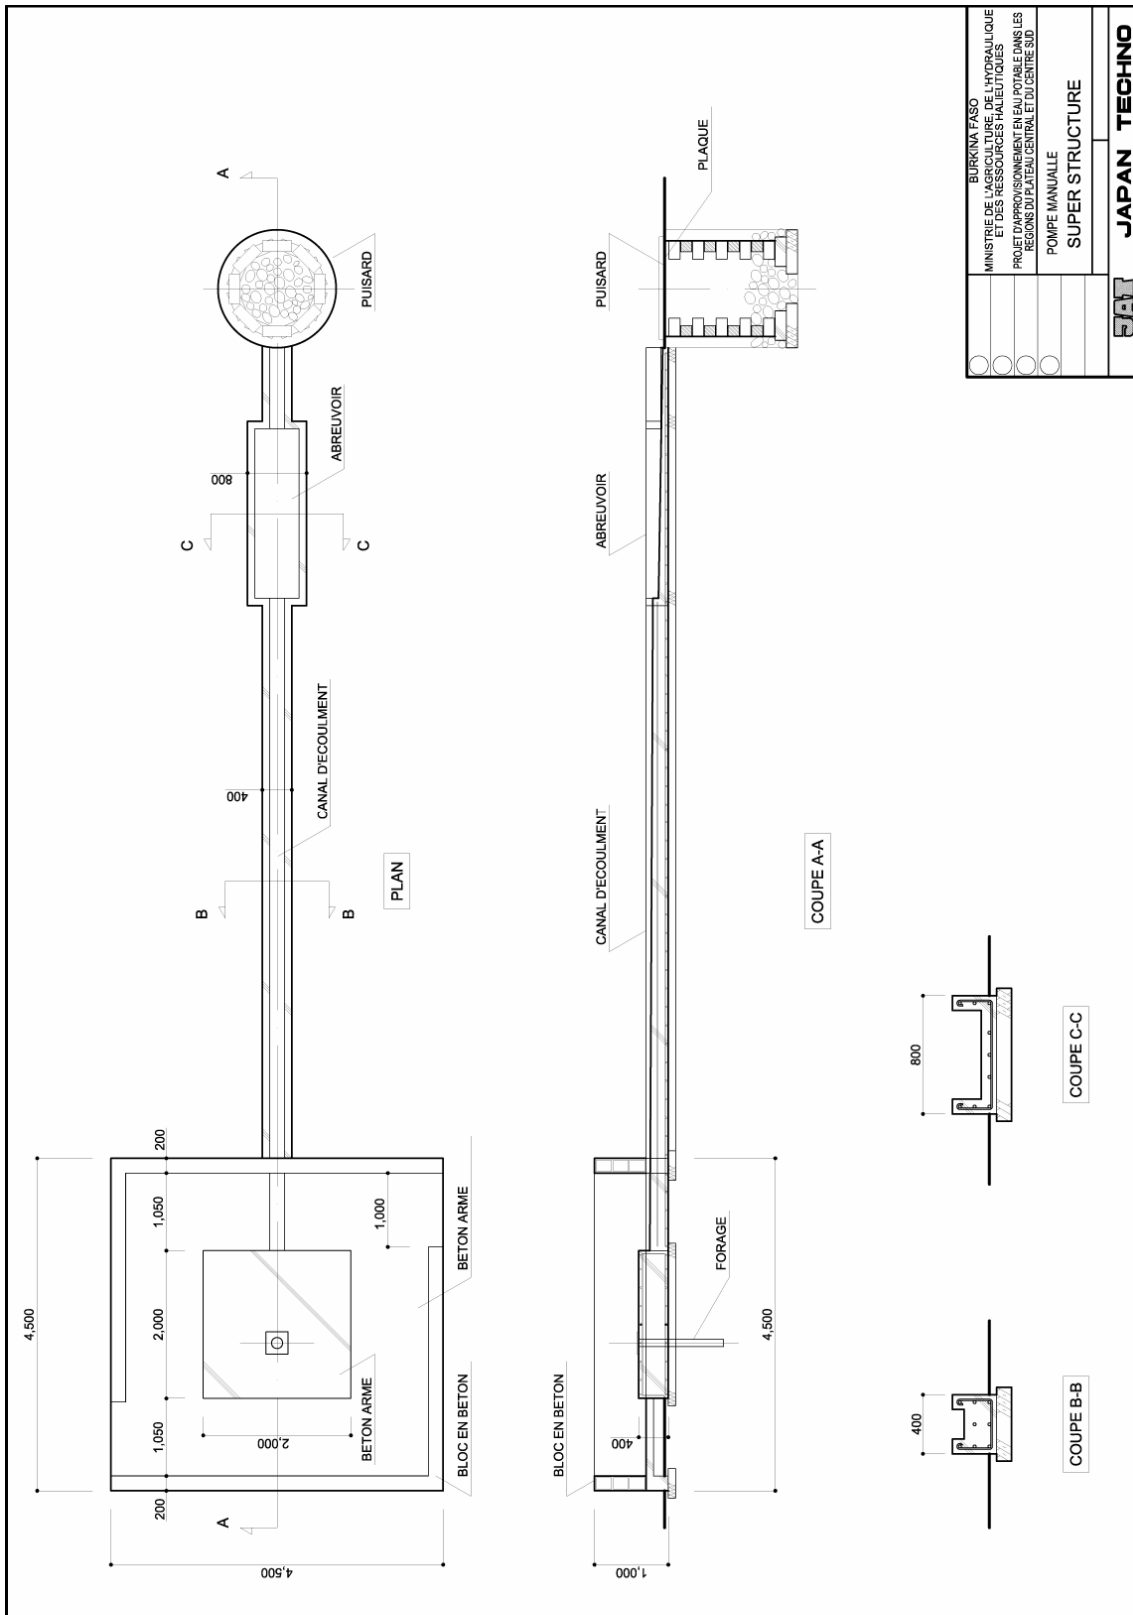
Plan de la superstructure du forage équipé d'un PMH
